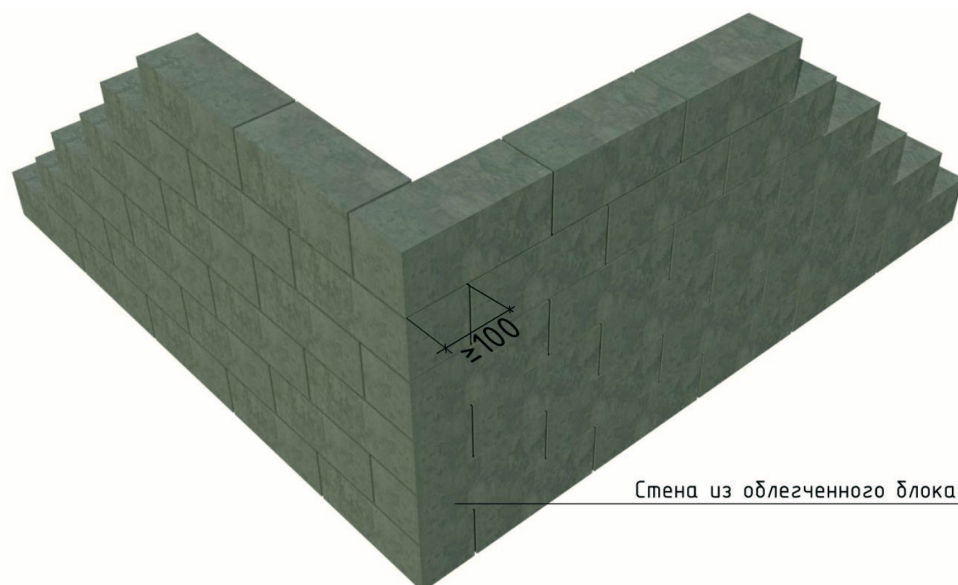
Цепная перевязка облегченных блоков с перекрытием швов на величину не менее 100мм.
